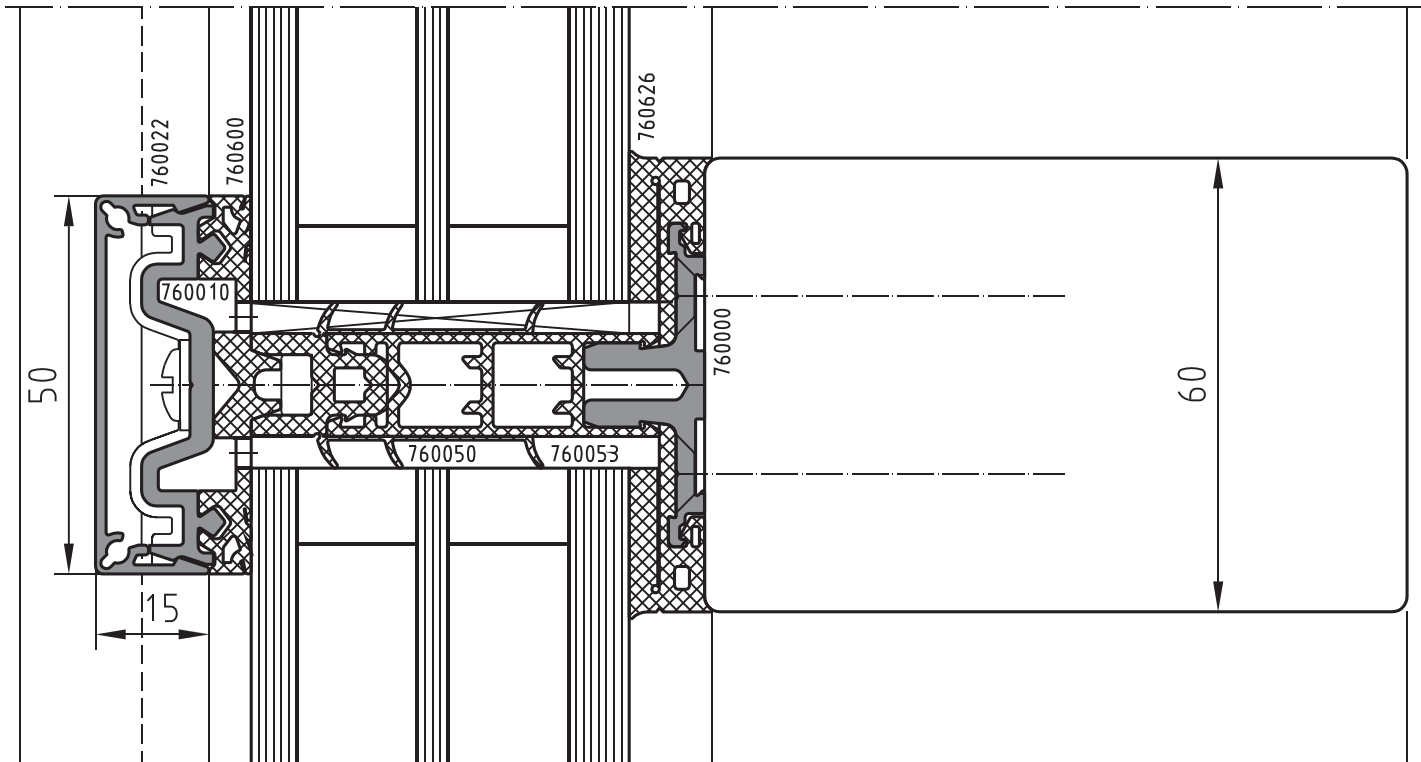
mm	Glasdicke	mm	Dichtung	U _f -Wert	Holzbreite 60 mm H0 und H3 Dämmprofil
